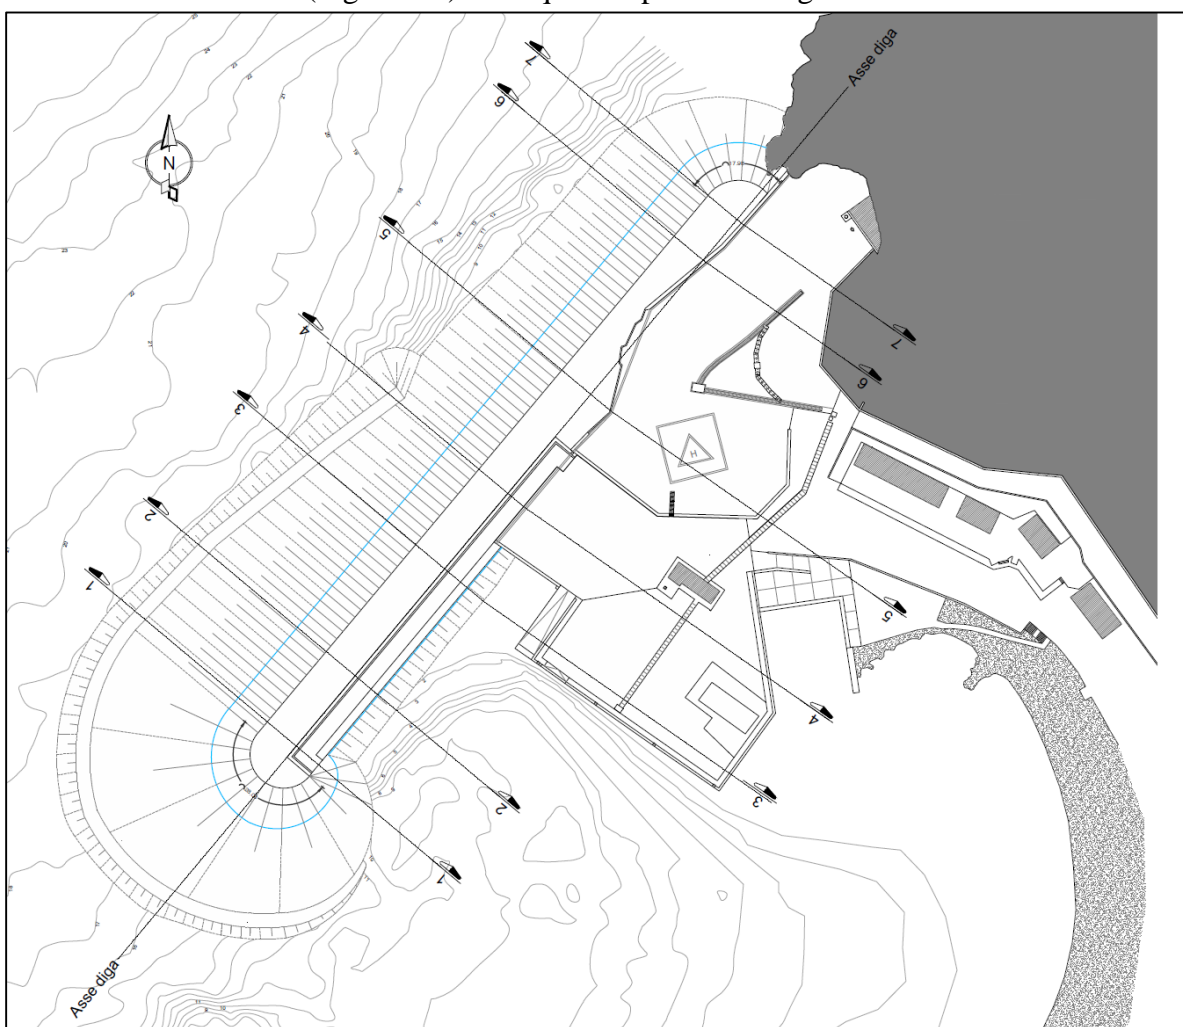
Planimetria di progetto con indicazione dell'ubicazione delle sezioni tipo
